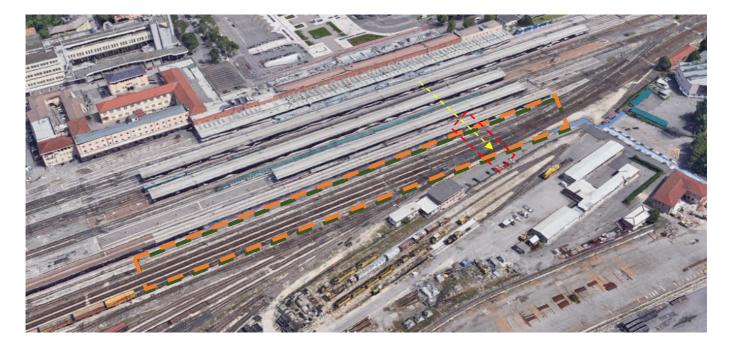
FV08 – Identificazione della posizione in vista 3D
